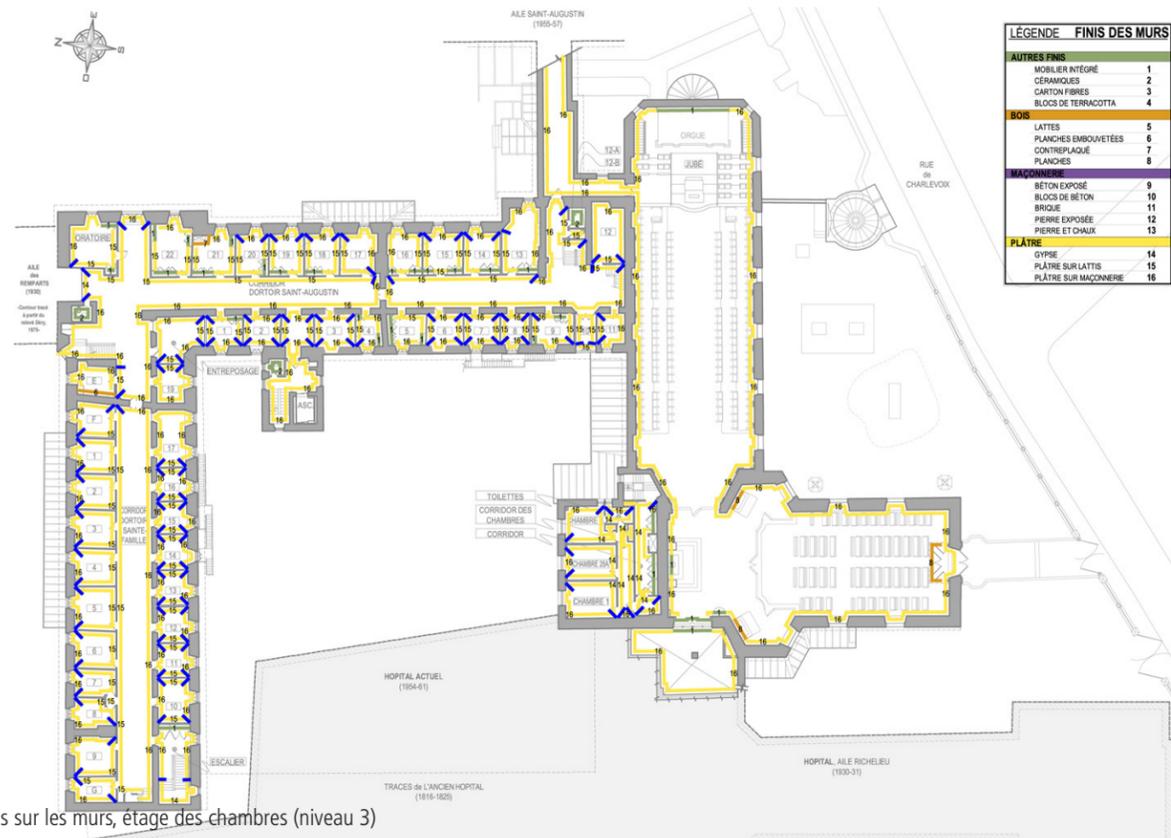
Plan des finis sur les murs, étage des chambres (niveau 3)
